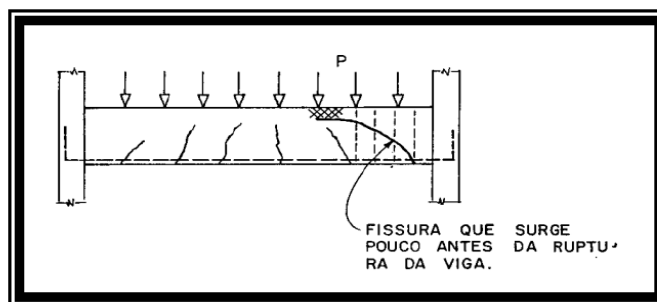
Fissuração de ruptura de vigas por cisalhamento –
